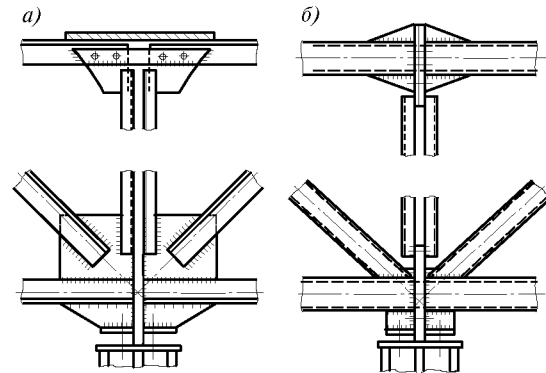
Монтажные узлы неразрезных ферм над промежуточными опорами
